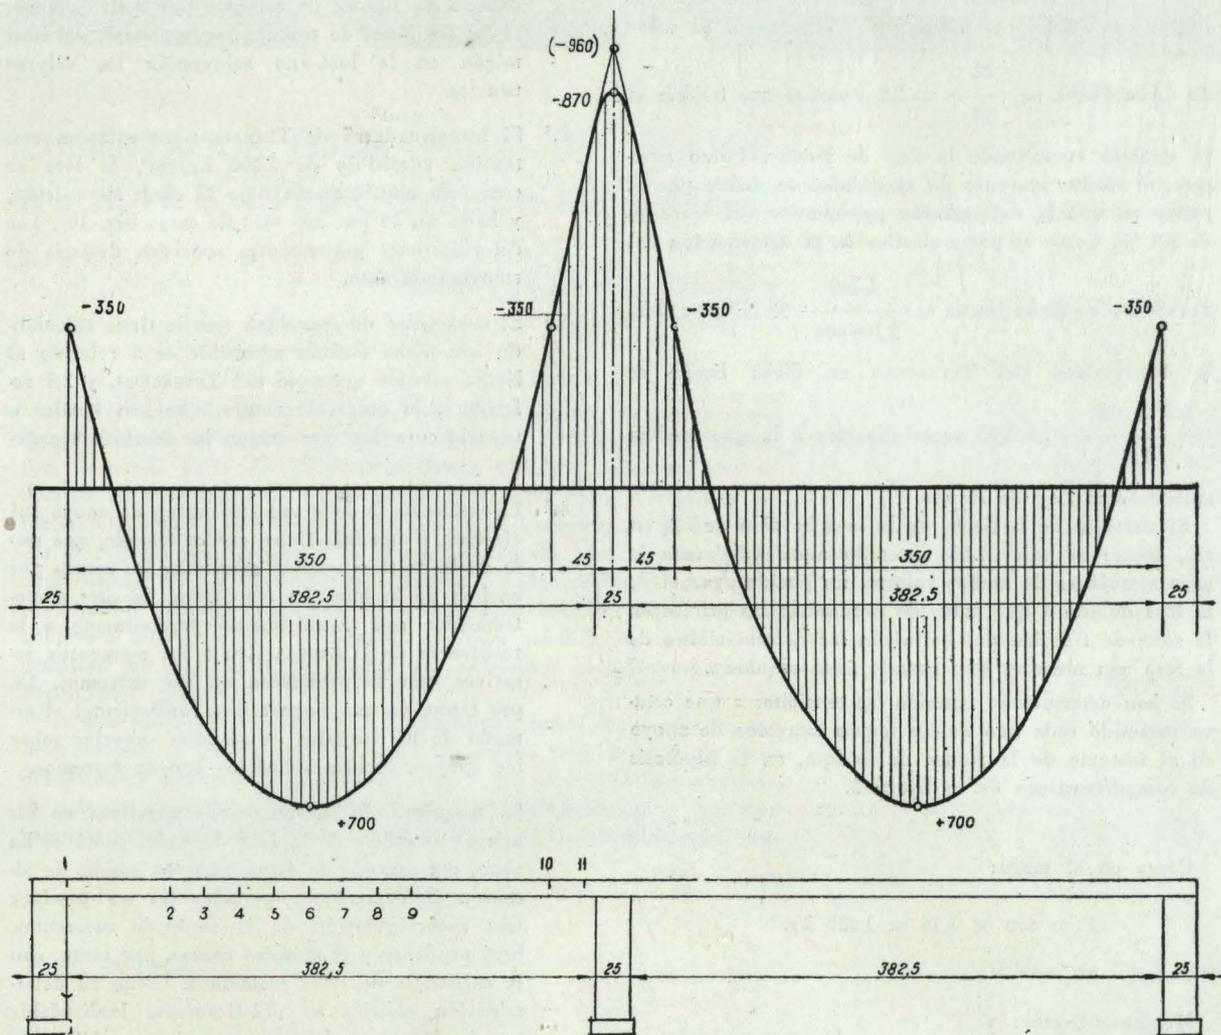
Losa de ensayo con la sobrecarga de rotura. Gráfica de momentos flectores y posición de las grietas en media losa.
